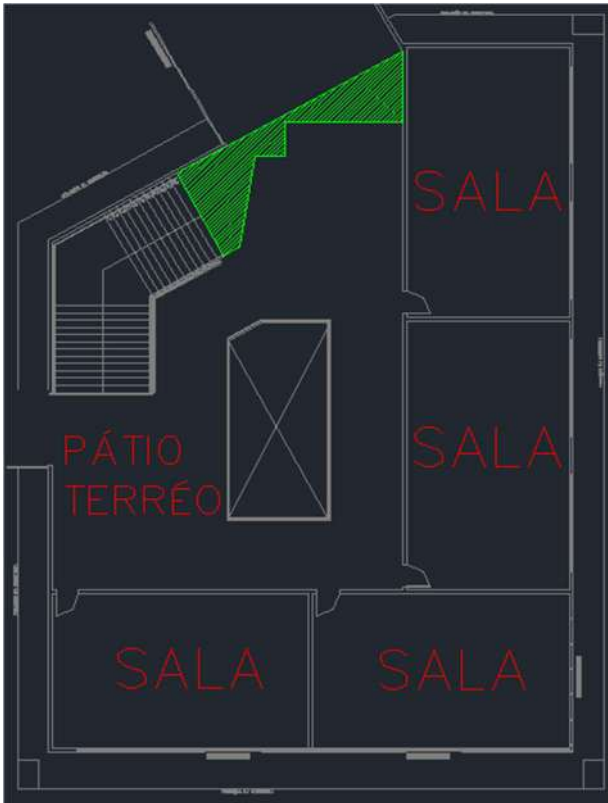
Piso sem granitina – Planta baixa 1º Pav. Bloco C
